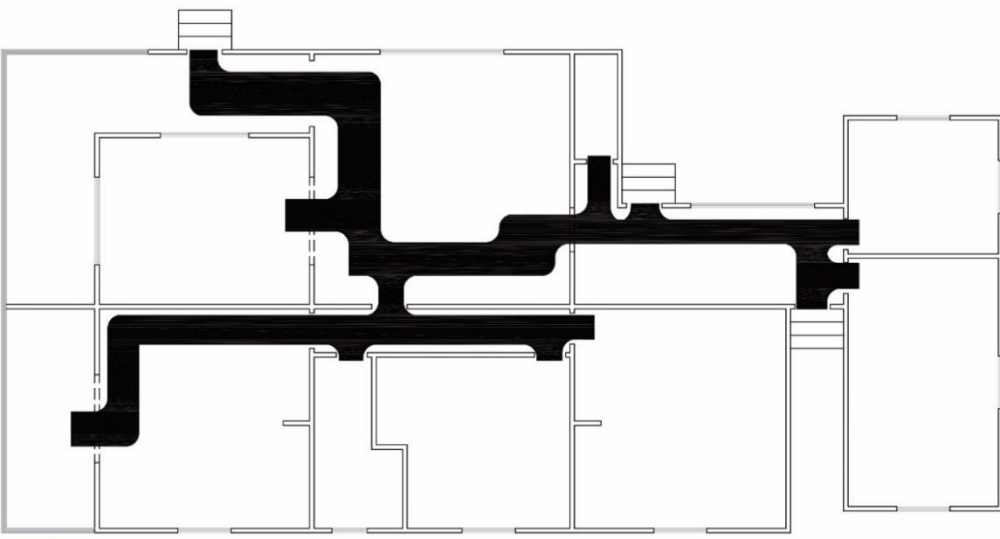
Axonometría del proyecto- Casa Galería tipo 1, Barrio Inglés.
